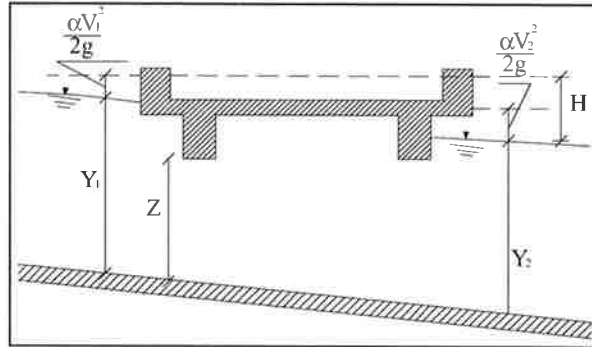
Sezione schematica di un ponte – Schema di calcolo
